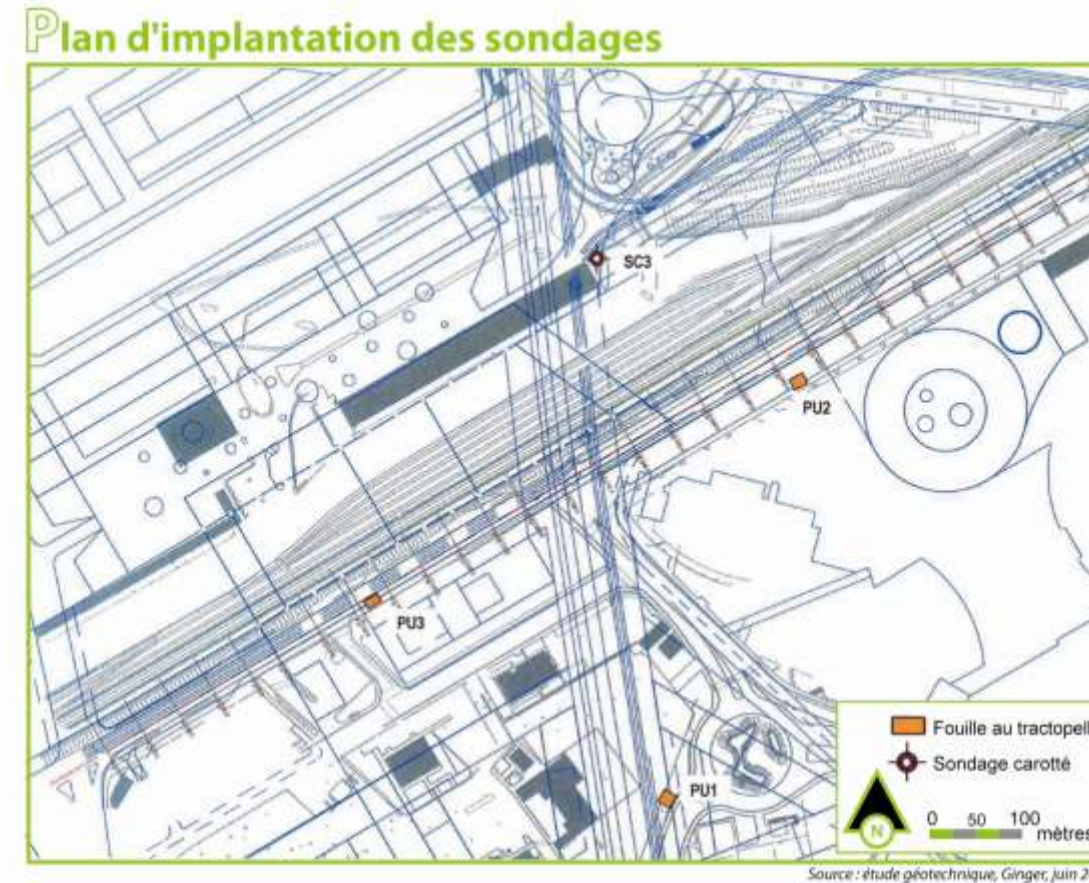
plan d'implantation des sondages géotechniques (Ginger)
